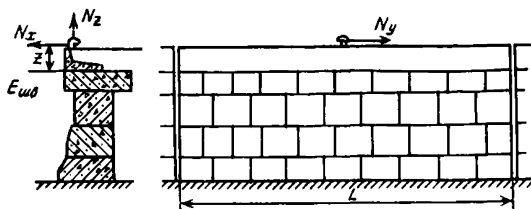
Поперечный разрез и фасад секции причальной набережной из массивовой кладки
